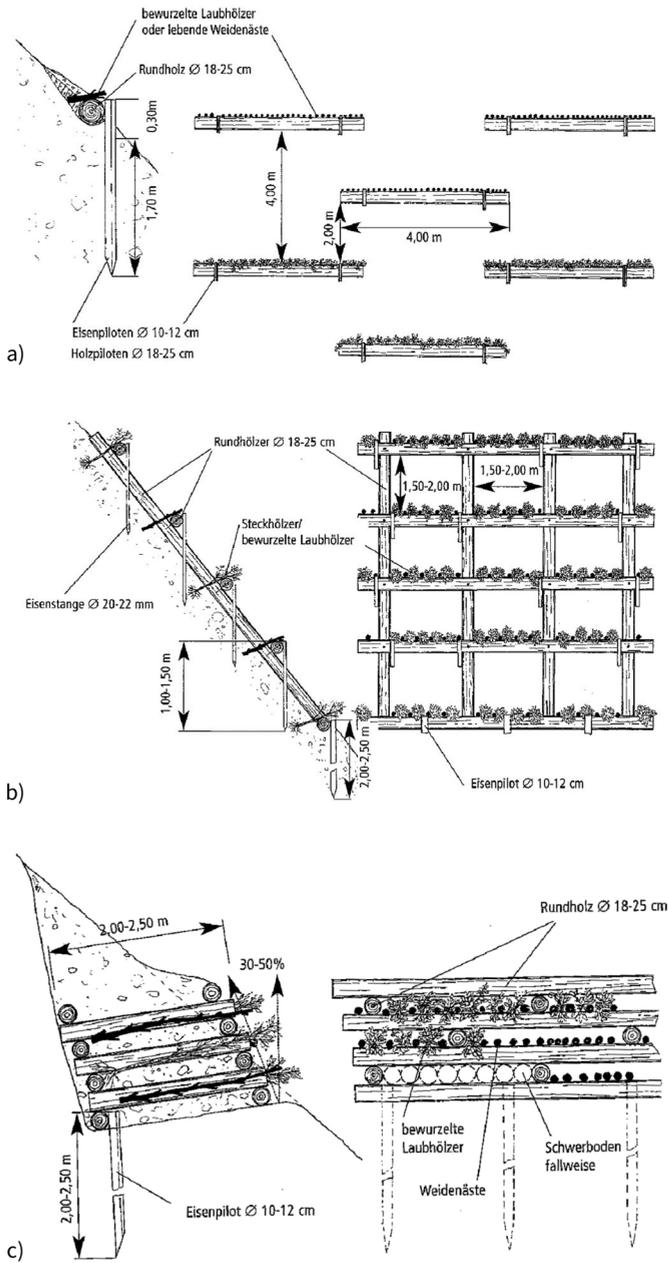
Beispiele ingenieurbioologischer Sicherungsmaßnahmen: Pilotenwand, Hangrost und Holzkrainerwand (nach [21]); a) bepflanzen Pilotenwand, b) lebender Hangrost an steilen Hängen, c) doppelwandige, bepflanzen Holzkrainerwand als Stützverbauung
